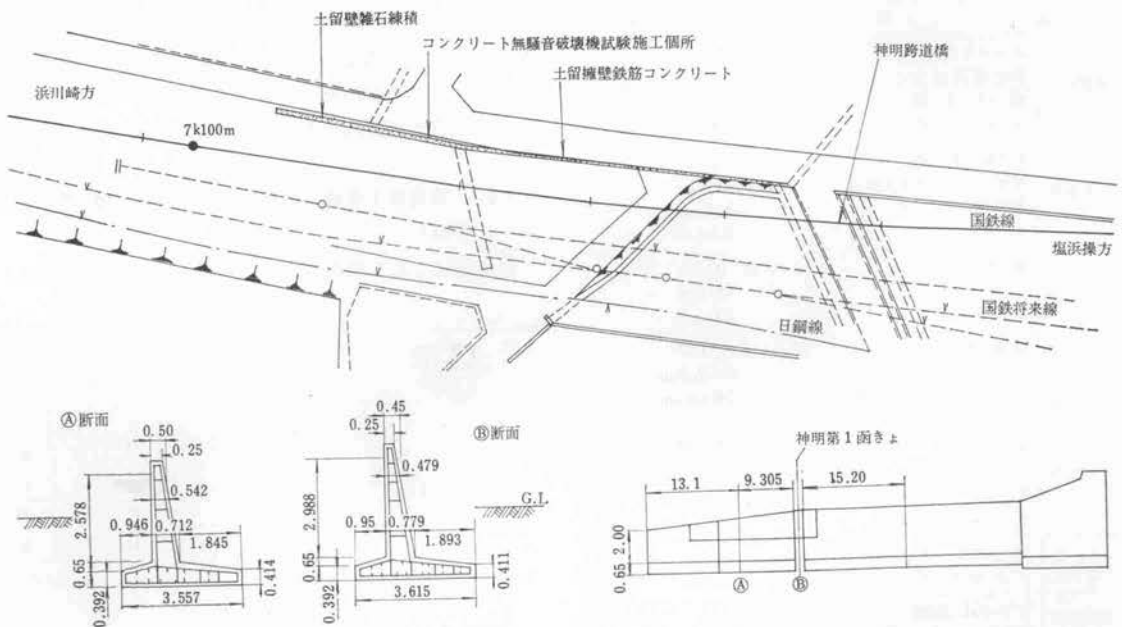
浜川崎支線 7k 100 m 付近土留擁壁とりこわし位置平面および断面図
